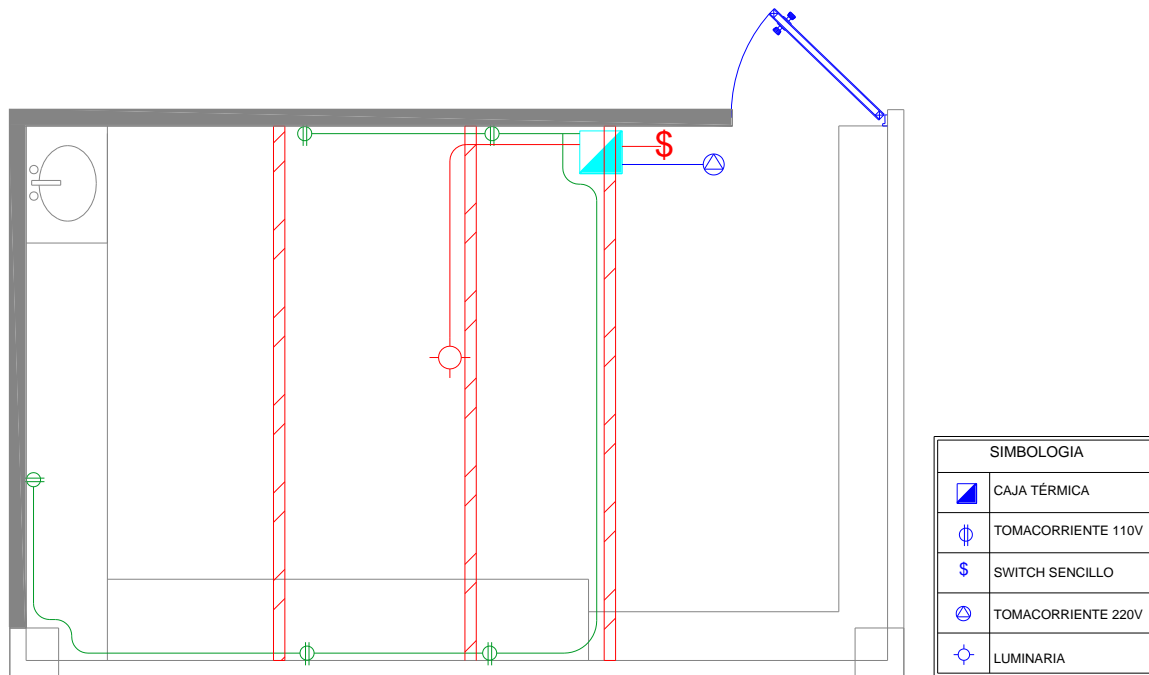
Vista de planta de la distribución de instalación eléctrica realizada en el laboratorio. [46]
